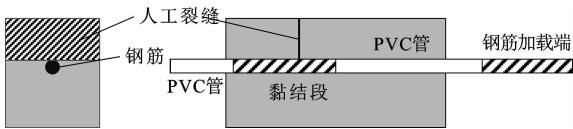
钢筋-混凝土拉拔试件裂缝引入方法
